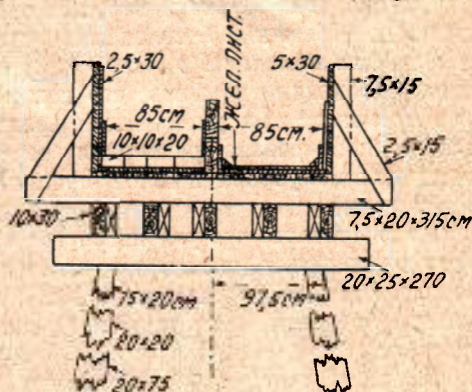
изображает сечение деревянного лотка (Engineering and Contracting, Apr. 17, 1912) простейшей конструкции, приготовленного на горных работах в Южной Америке местными плотниками (Колумбия). Конструкция ясна из чертежа. Лотки обыкновенно делаются короткими—3—3,60 м длиной—и соединяются между собой для удобства сборки и разборки. Устанавливаются они на грунте,
